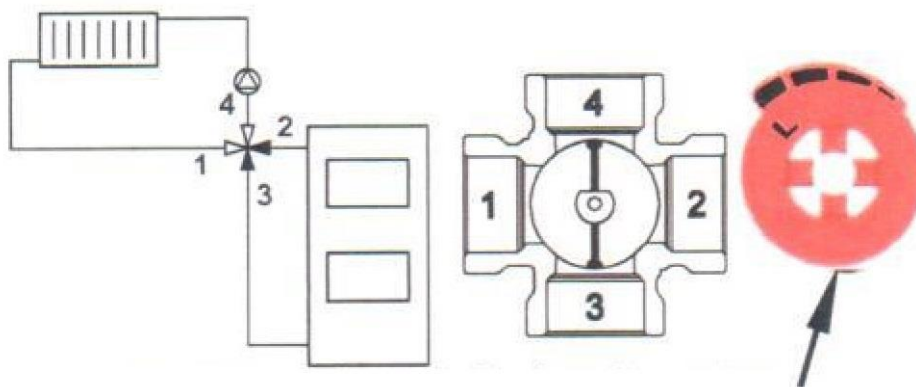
Hydraulické zapojení pohonu MIXu – pravé provedení
